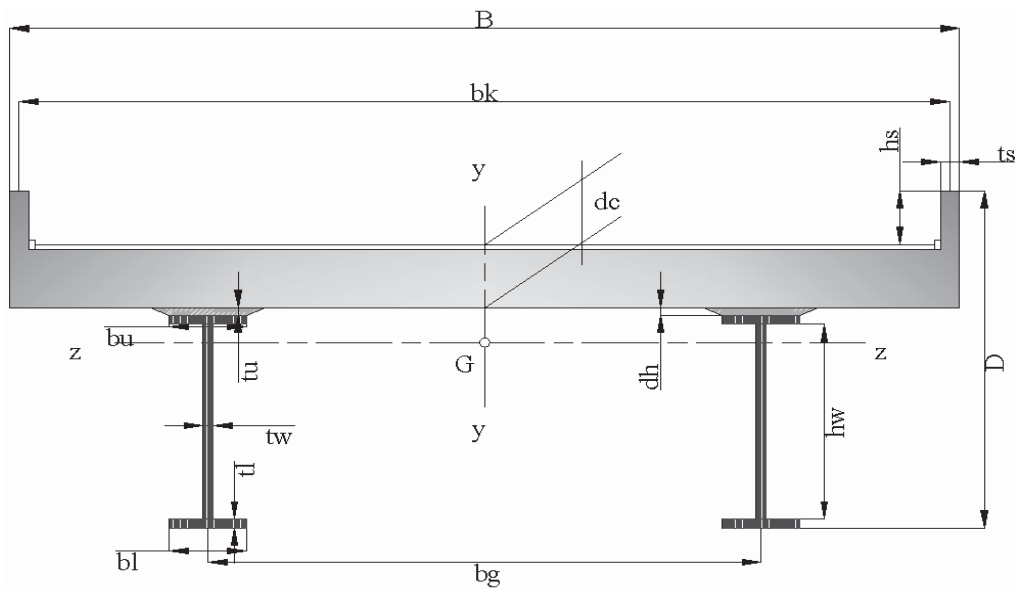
sección transversal de un puente apoyado sobre dos vigas de acero
